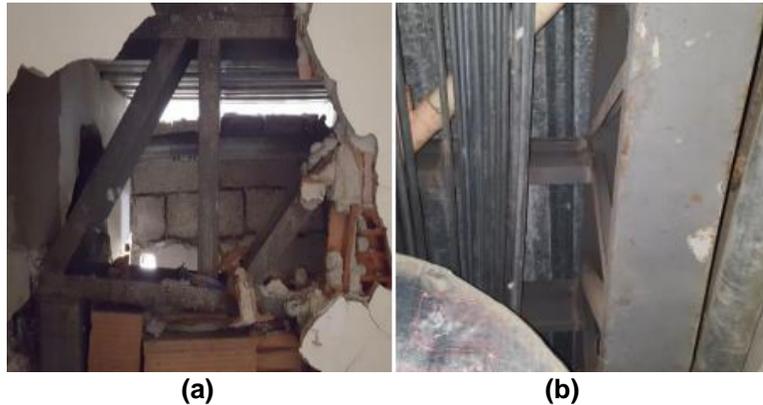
Vigas en celosía, (a) La columna de apoyo no era continua, esta se perdía en el cordón inferior de la armadura y continuaba desde el cordón superior de la armadura. (b) Las vigas secundarias se apoyan sobre los elementos verticales de la cercha con una conexión artesanal de soldadura.
